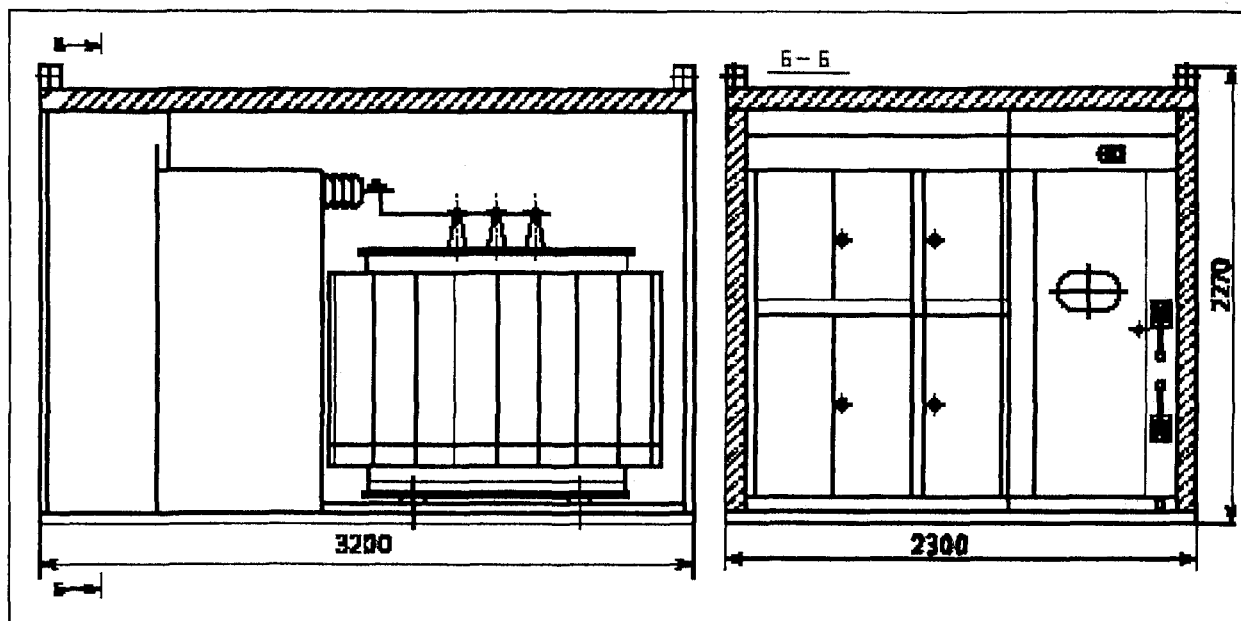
Общий вид и габаритные размеры подстанции типа КТП-Т
